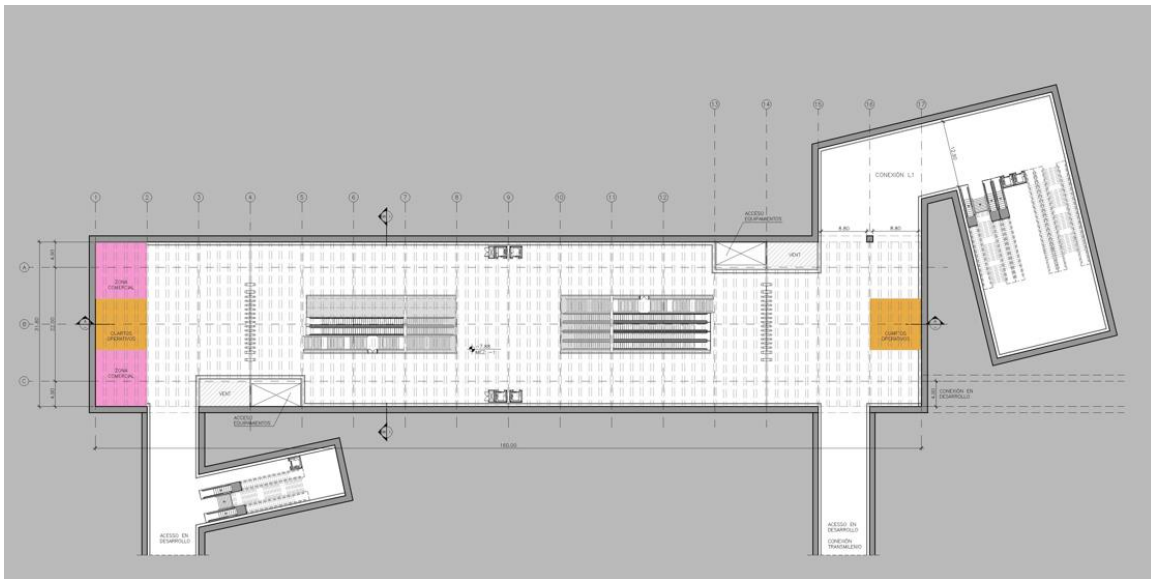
Planta Estación 1 Vestíbulo (-7,88)
